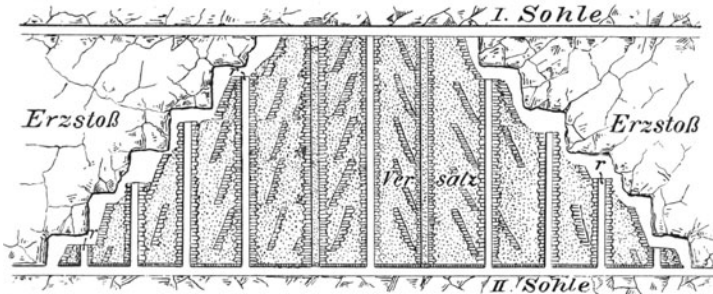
Schema des Firstenbaues auf Erzgängen.
